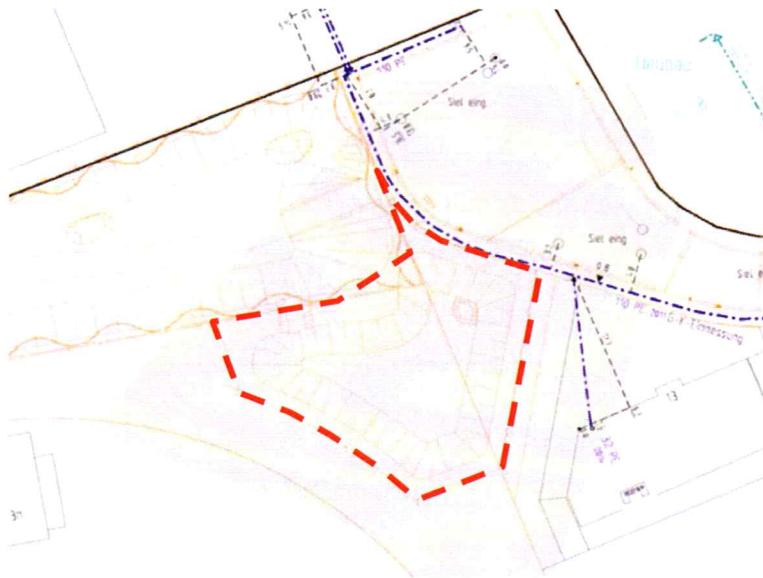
Lageplan Mitteldruck-Gasleitung (blau) mit Plangebiet (rot) (Quelle: SH Netz AG, verändert)
